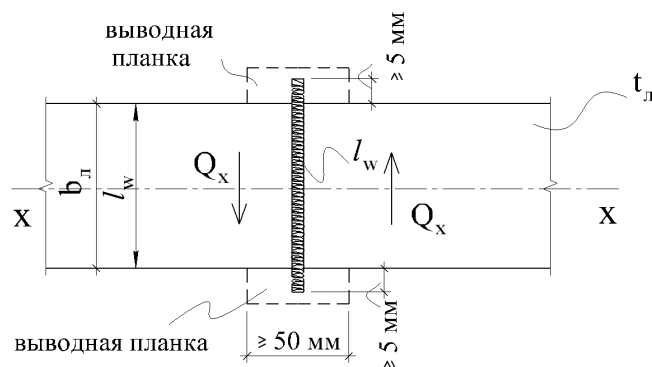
Схема сварного стыка двух листов, нагруженных поперечной силой Q_x
